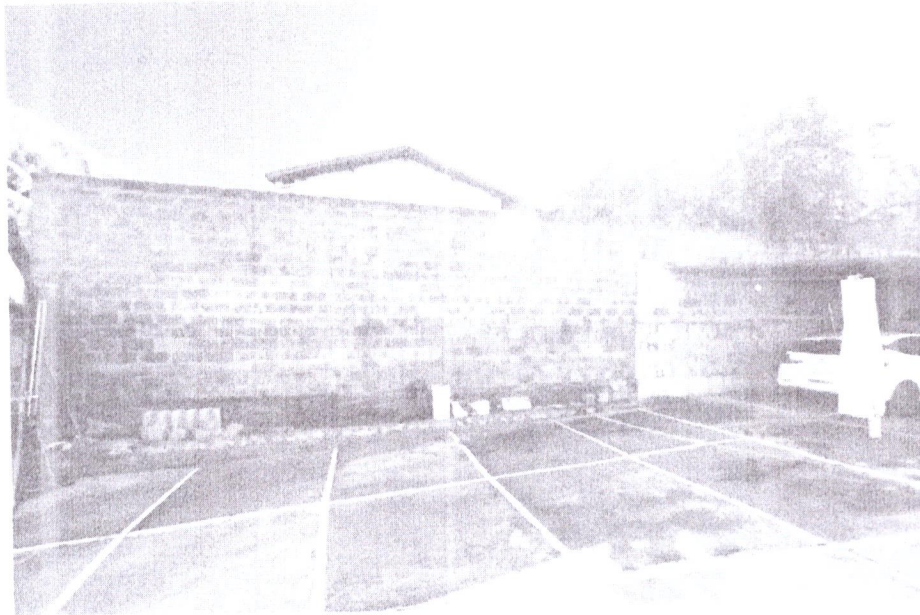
Vista do muro entre a Unidade 03 (inferior) e Unidade 01 (superior)
